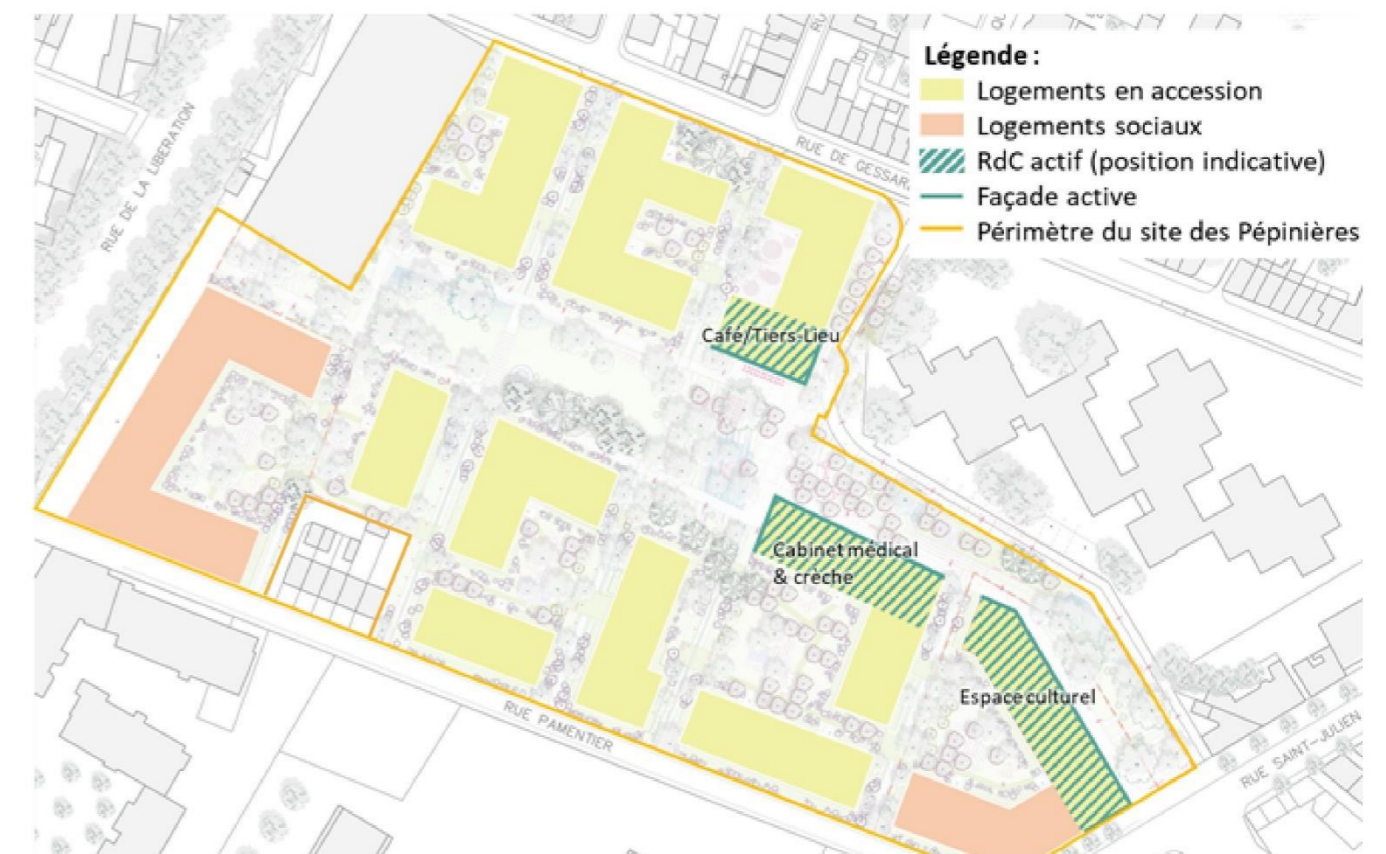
Plan prévisionnel des rez-de-chaussée actifs (COGEDIM-VIRGIL, Juin 2022)
